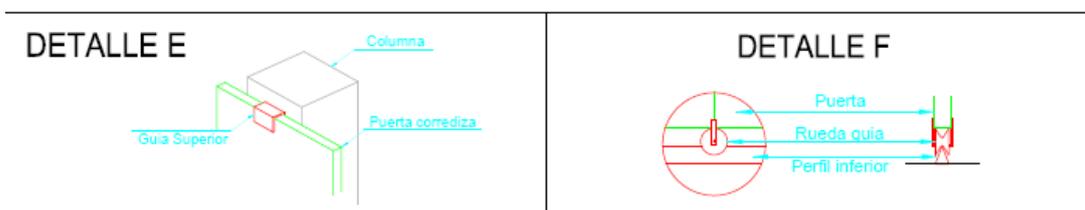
Detalles de anclaje para puerta corrediza en columna de hormigón armado o perfil metálico.
